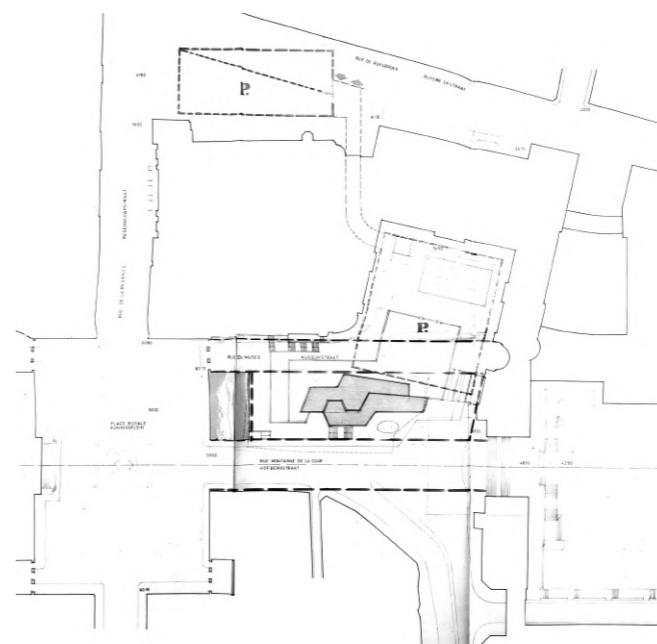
Plan schématique illustrant le dégagement du portique de la rue du Musée vers la rotonde, le parking de la rue Ruysbroeck et le tunnel.
